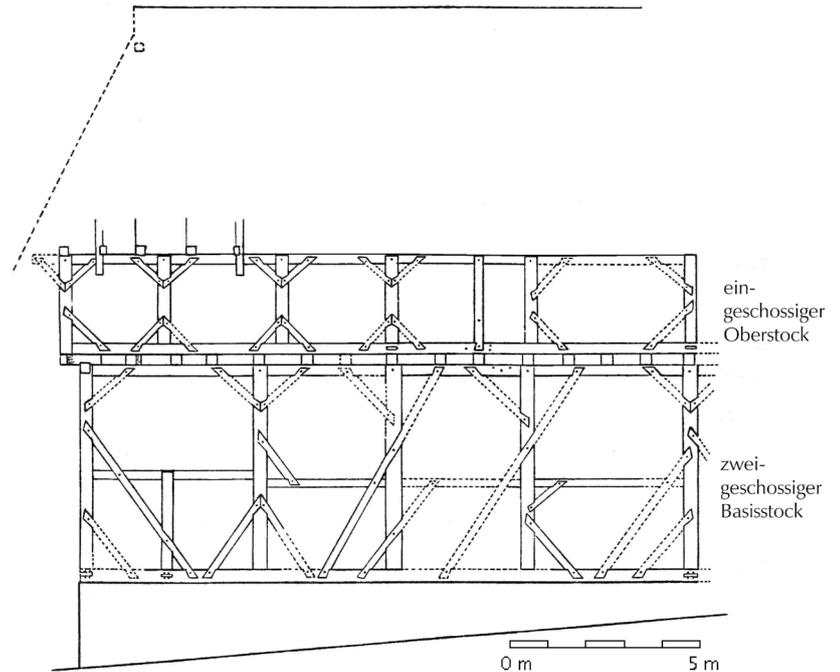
Zweistöckiges Traufgerüst mit zweigeschossigem Basisstock und eingeschossigem Oberstock. Schwäbisch Hall (Lkr. Schwäbisch Hall), Untere Herrngasse 2, 1289 (d).
